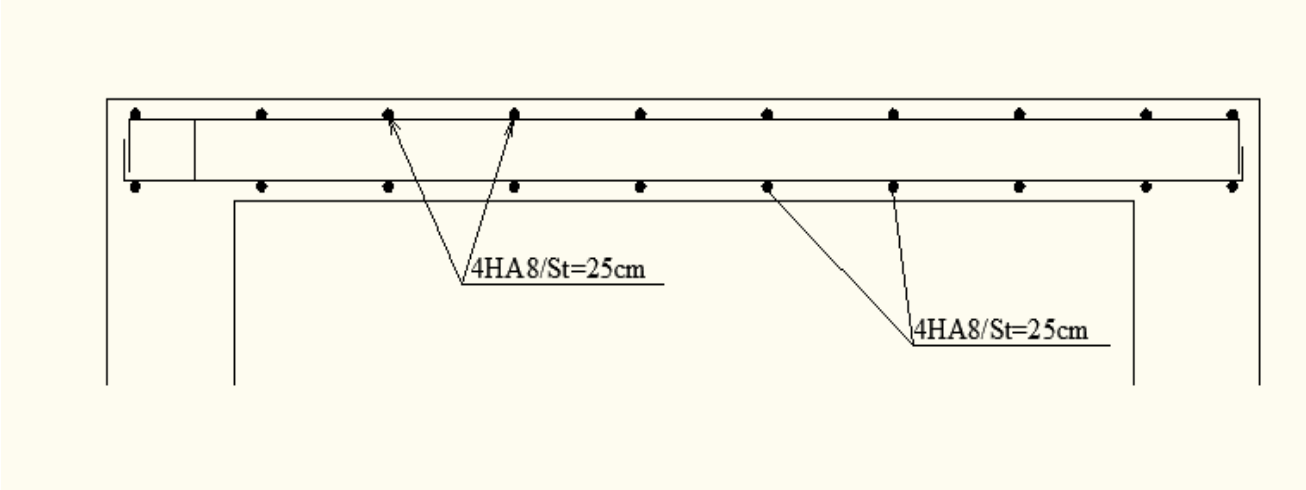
Plan de ferrailage de la salle machine suivant y-y.
